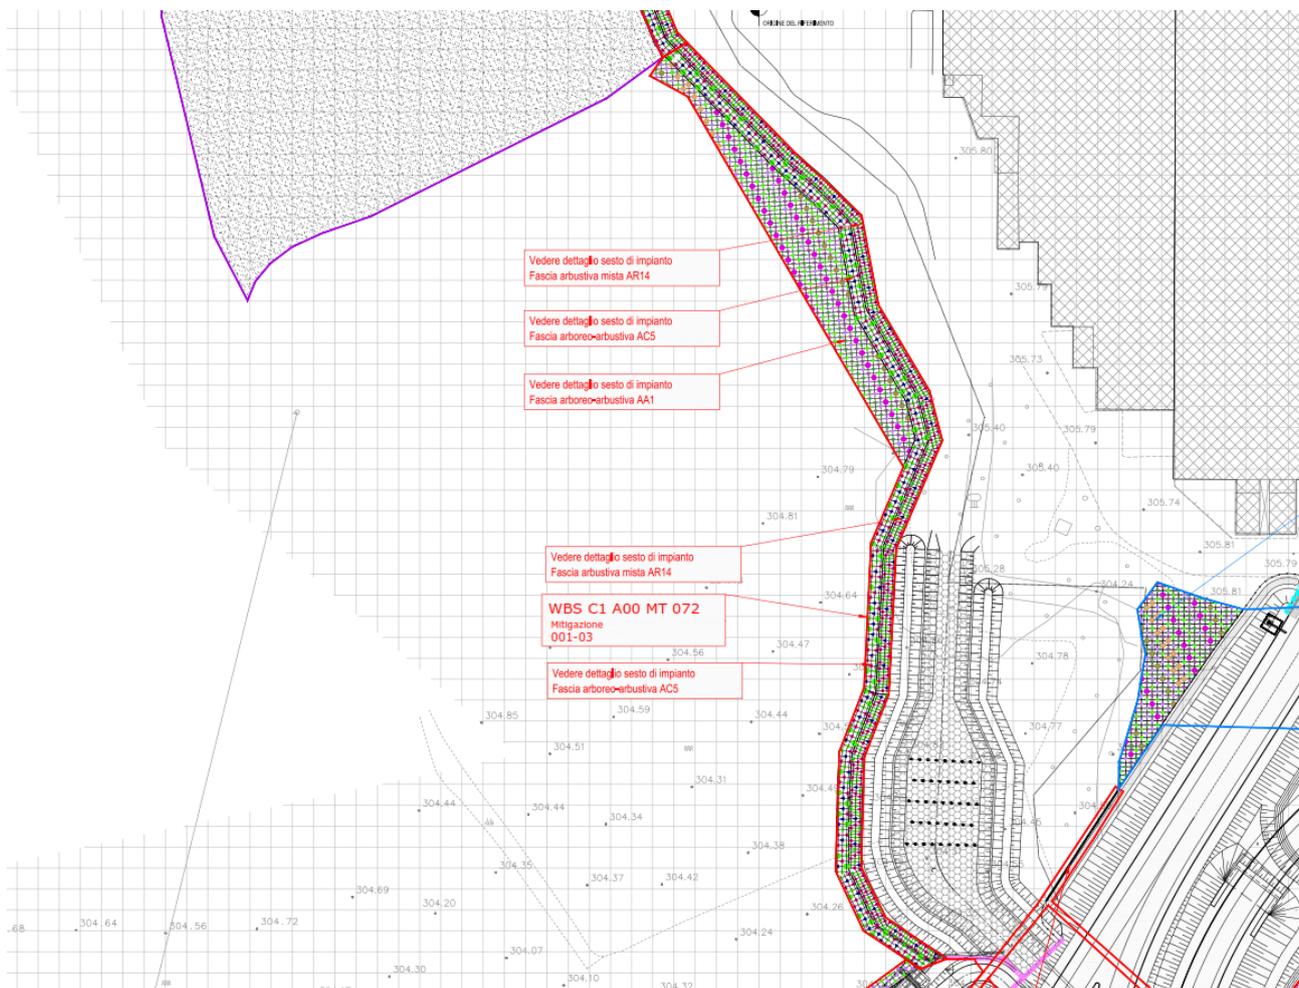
planimetria as built delle mitigazioni a verde nell’area del fiume Seveso (A59)
